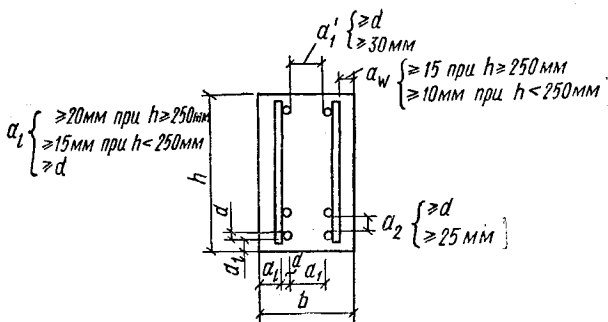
Размещение арматуры в поперечном сечении балок
